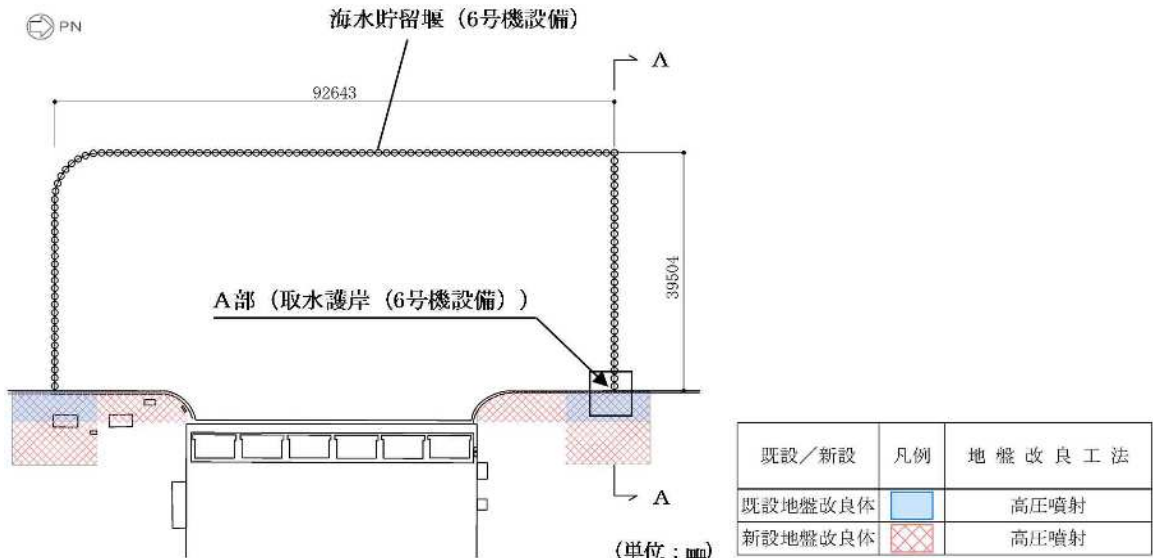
(1) 取水護岸（6号機設備）の平面図
